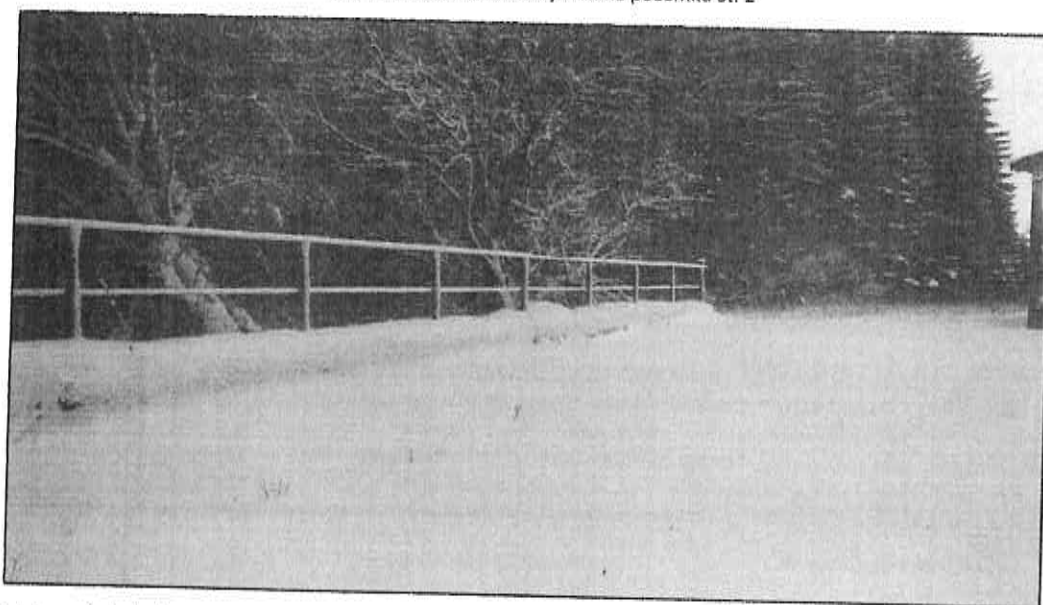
Zpevněná plocha mezi halou a železobetonovou jímkou na pozemku St. 2 a náletové porosty na pozemku parc. č. 152/2
